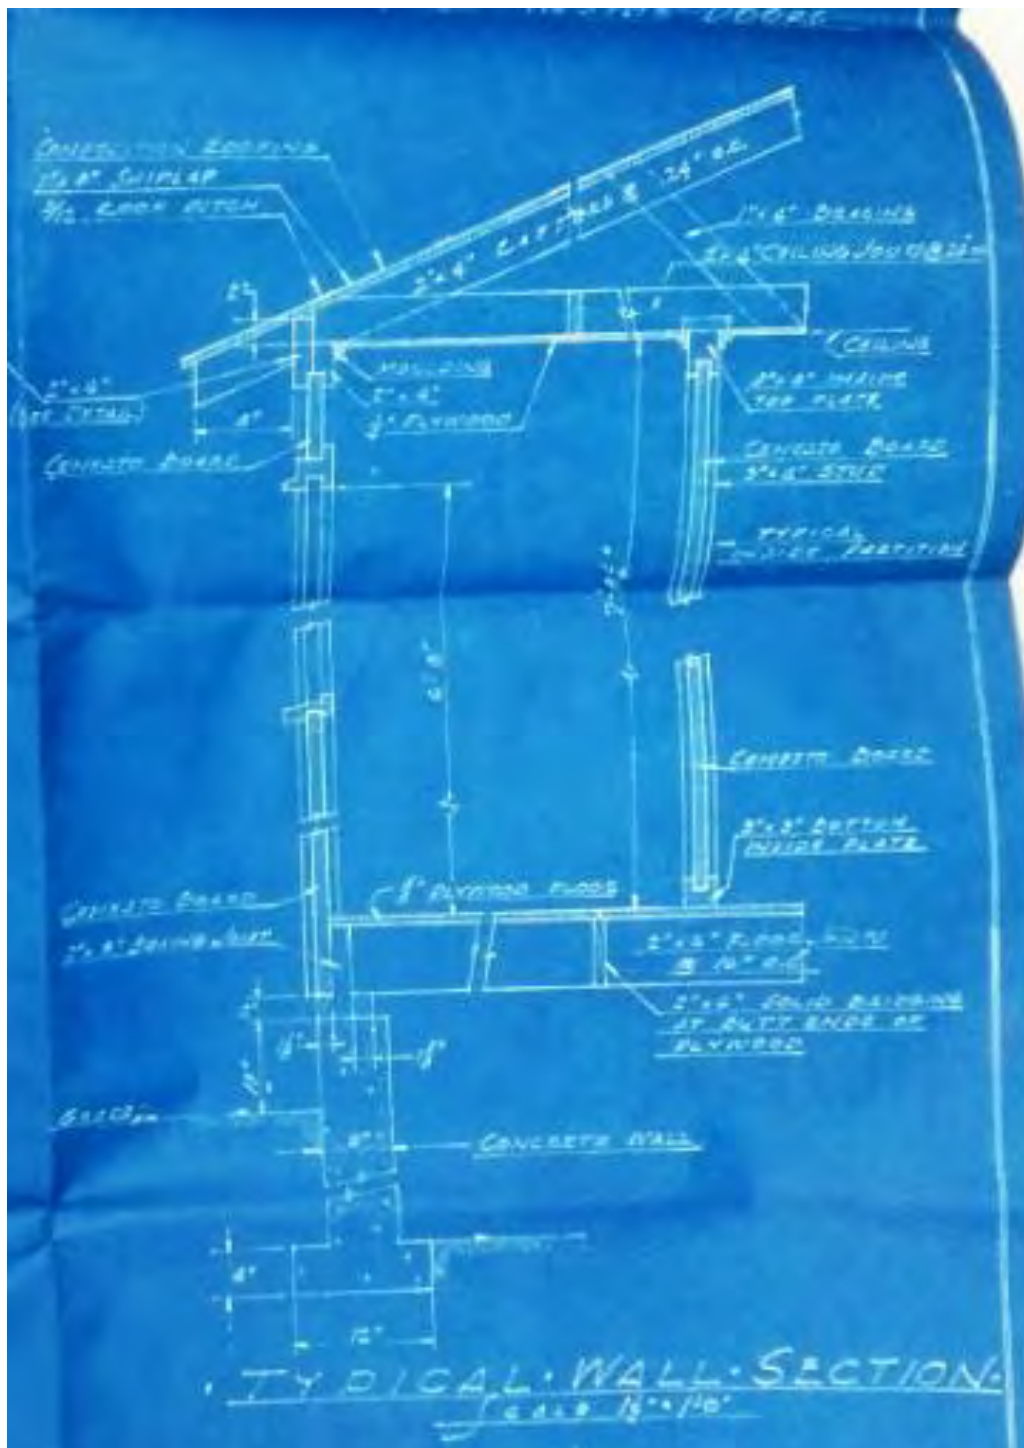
Detalle de plano de casa modelo B con módulos prefabricados de *cemesto*. Se muestra la sección típica de muro con el sistema de paneles de este producto. El *cemesto* es un material de construcción compuesto, robusto, liviano, impermeable y resistente al fuego, hecho de un núcleo de tablero aislante de fibra de caña de azúcar que es recubierto en ambos lados con asbesto y cemento. Su nombre es una palabra que combina los términos de “cemento” y “asbesto” en el idioma inglés. Este modelo de vivienda tenía un costo de producción de \$2,850 dólares.
